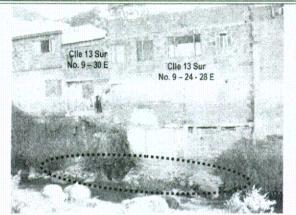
Asentamientos y grietas observadas en los muros adyacentes al cauce del río San Cristóbal, ubicados en la parte posterior de la vivienda del señor Juan Martínez (Calle 13 Sur No: 9 – 24 Este).
